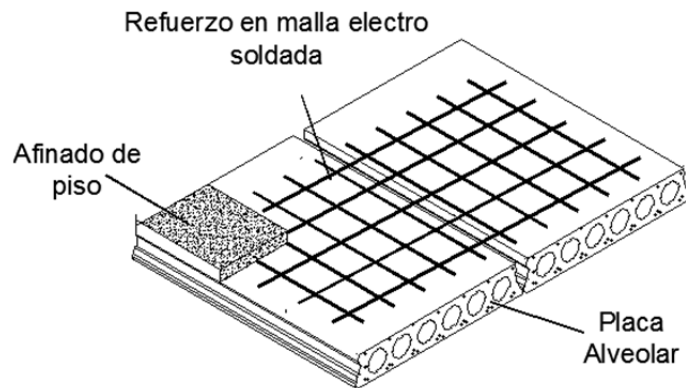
Detalle constructivo de un sistema de entepiso en losas alveolares
